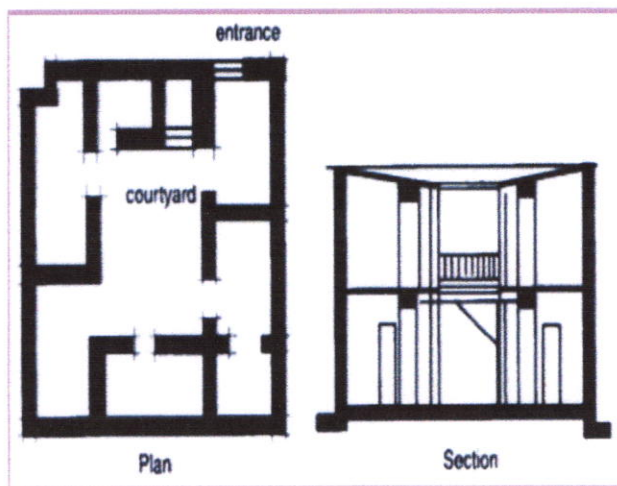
plan et coupe d'une maison de Ur, Mésopotamien Source : Hamdan, Rasdi, 2002
